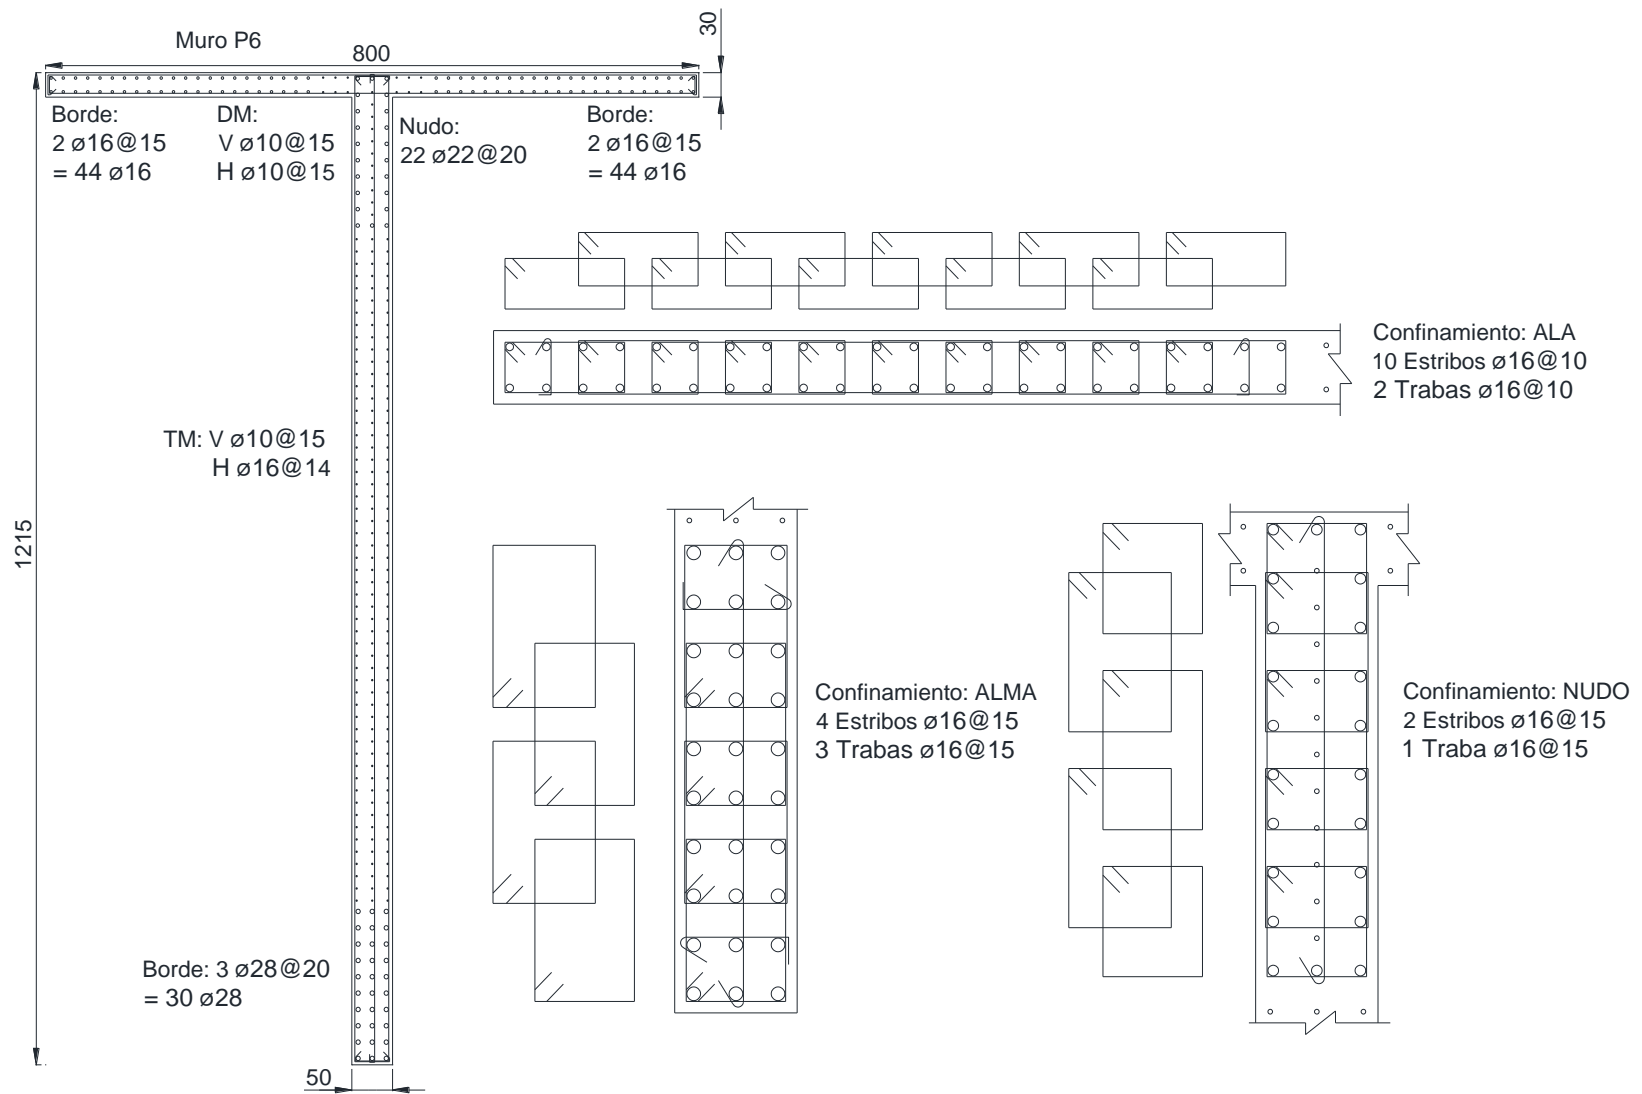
Armadura longitudinal, transversal y de confinamiento para el muro P6
